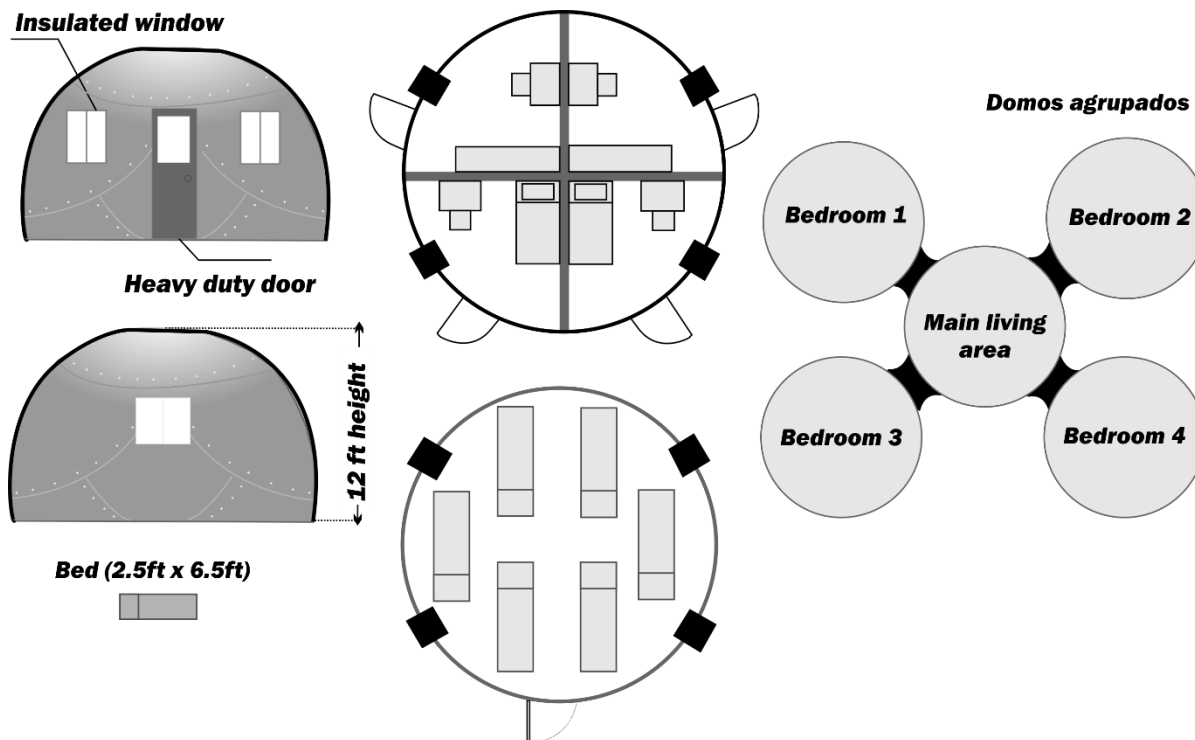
Planimetría esquemática del Intershelter. Fuente: Tomado de <http://www.intershelter.com/hunting.html>
